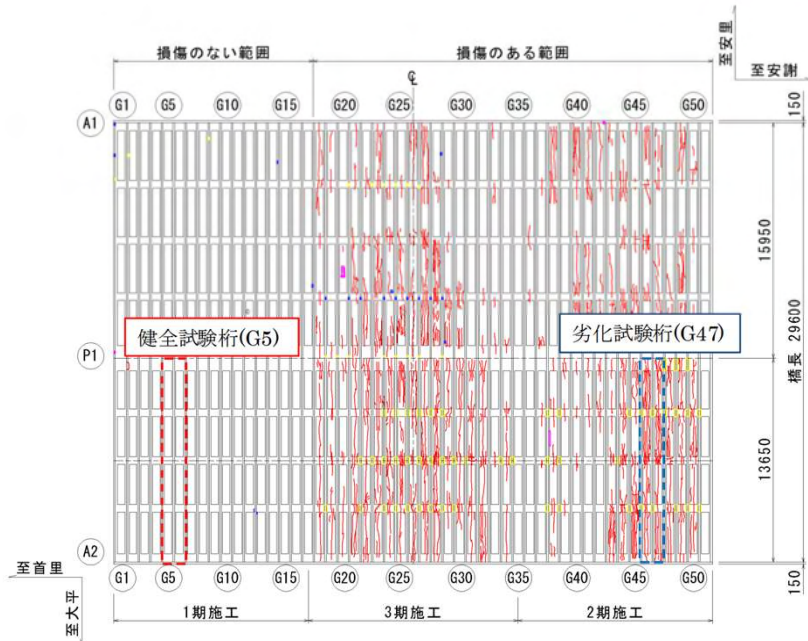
古島橋 PC 桁下面のひび割れ発生状況 (単位: mm)
